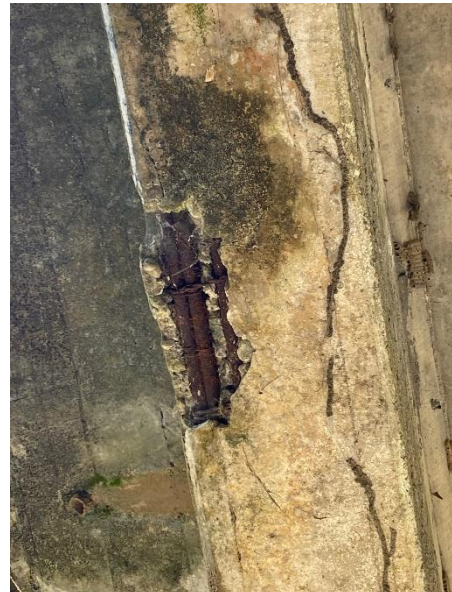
Acero de refuerzo expuesto en viga de concreto (Autoría propia, 2021).
